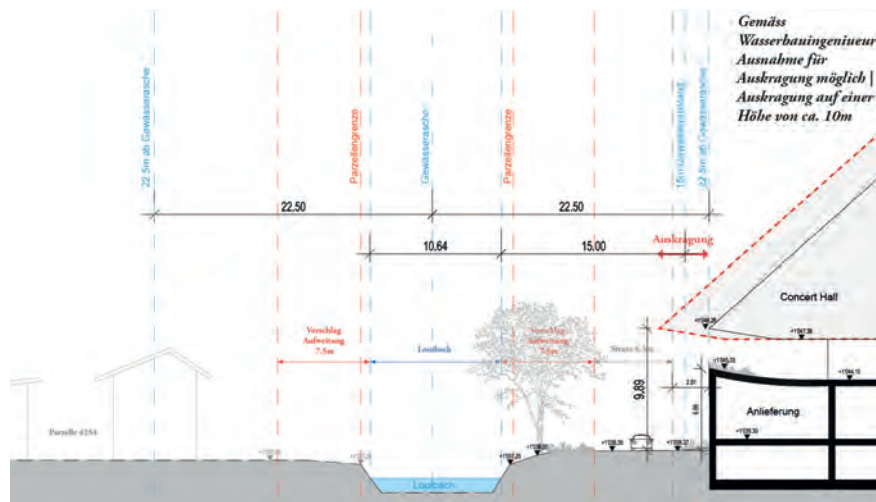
Schnitt Louibach Nord - Süd mit Auskragung der Konzerthalle in den Gewässerraum
